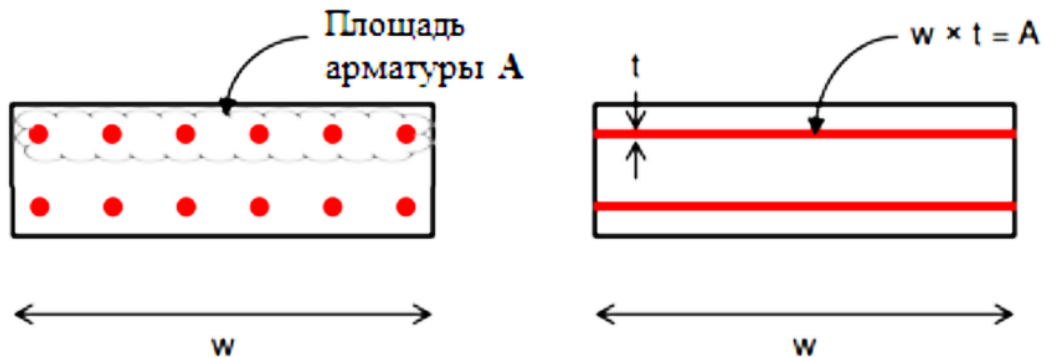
Схема распределения армирования по толщине сечения железобетонной конструкции
